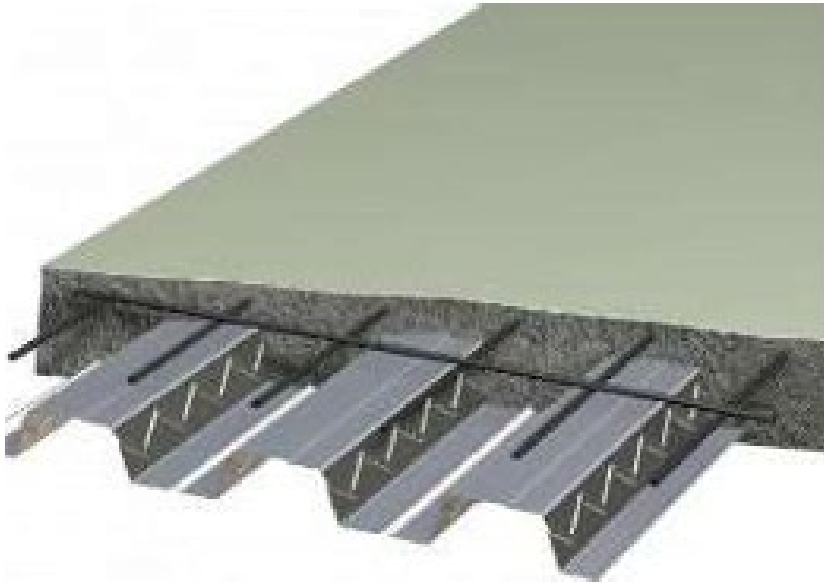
Конструкція монолітного перекриття з незнімною опалубкою
